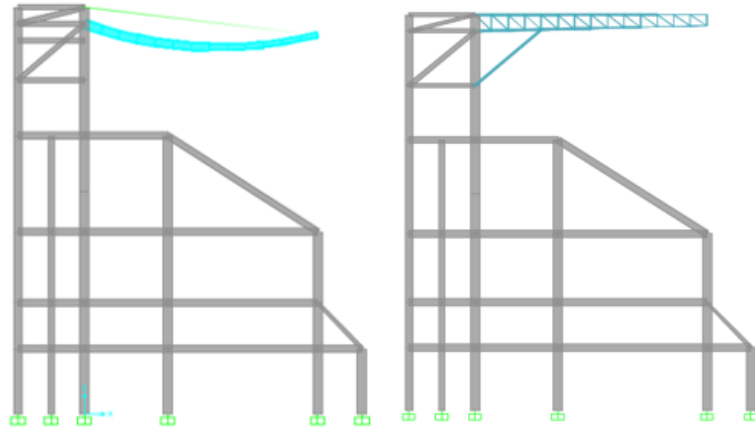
Vista en el plano xz del diseño de la Tenso estructura y la Cercha.
